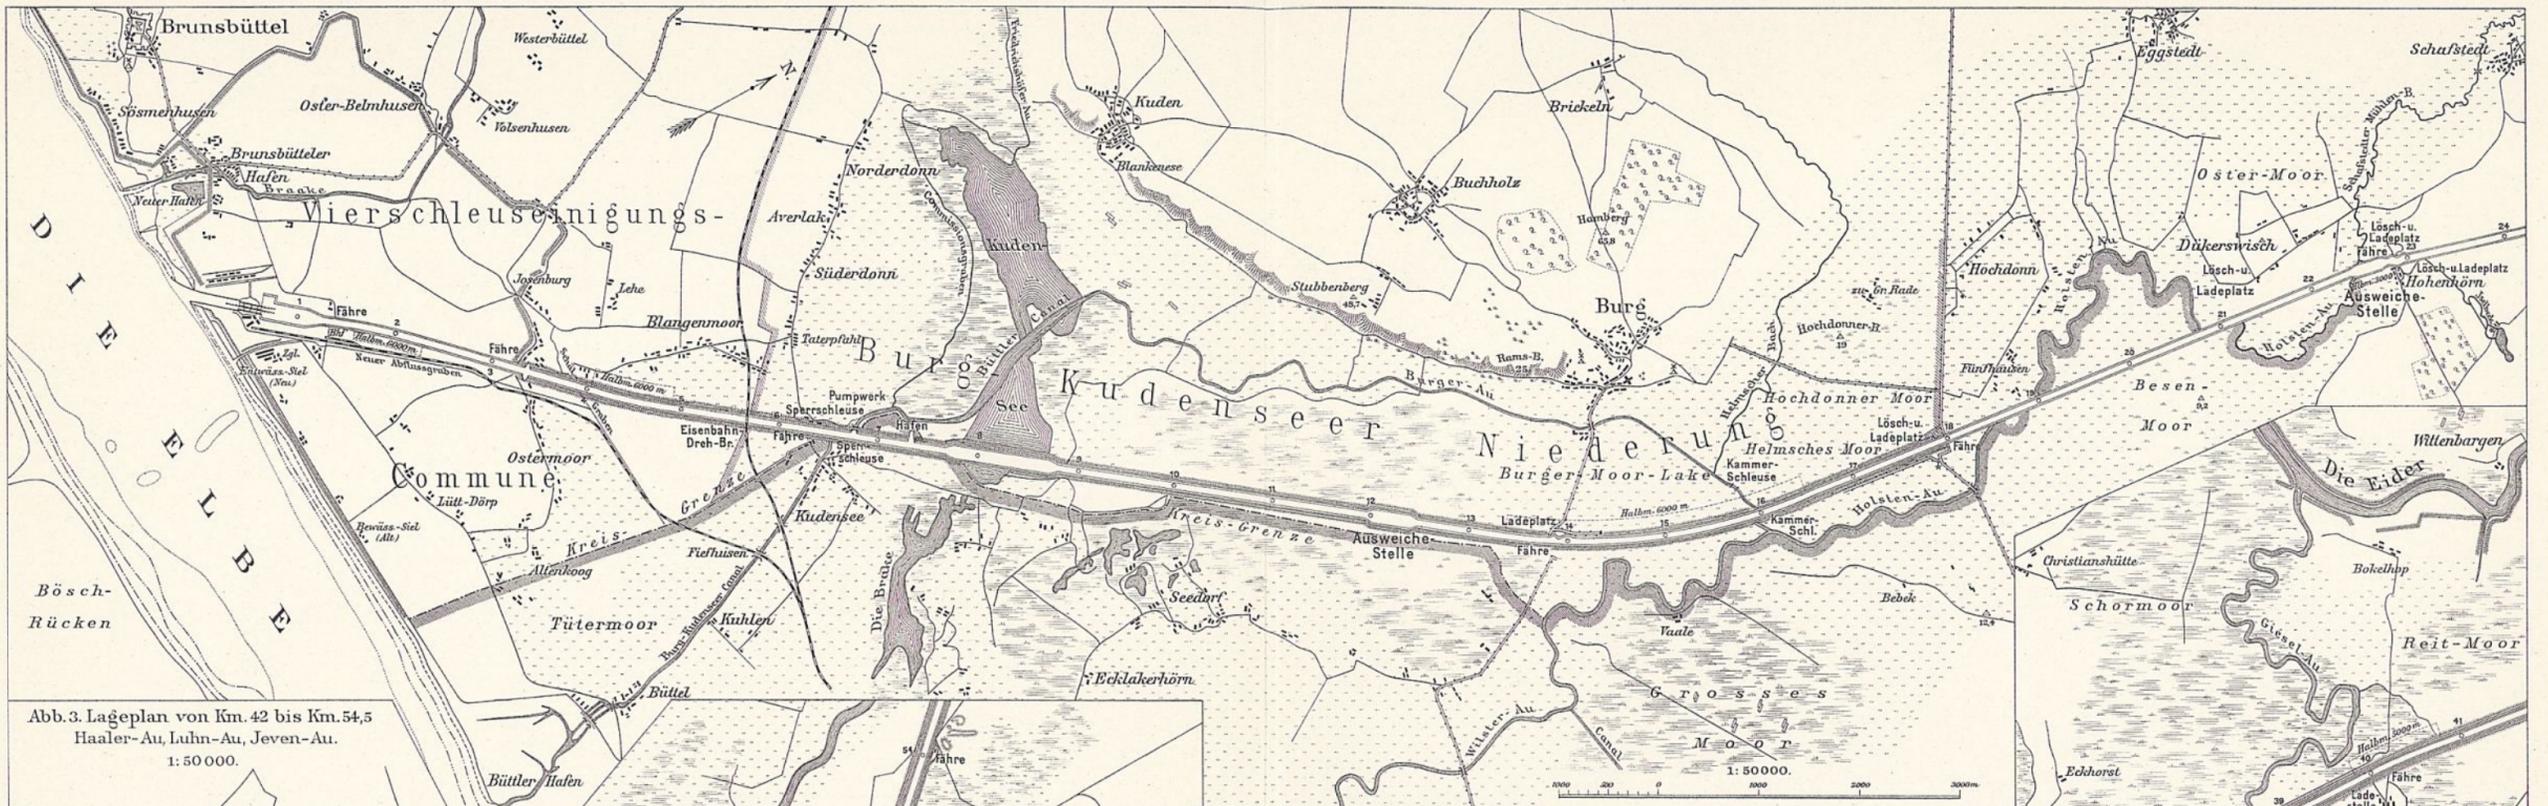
Lageplan von Km. 42 bis Km. 54,5 Haaler-Au, Luhn-Au, Jeven-Au. 1:50 000.
